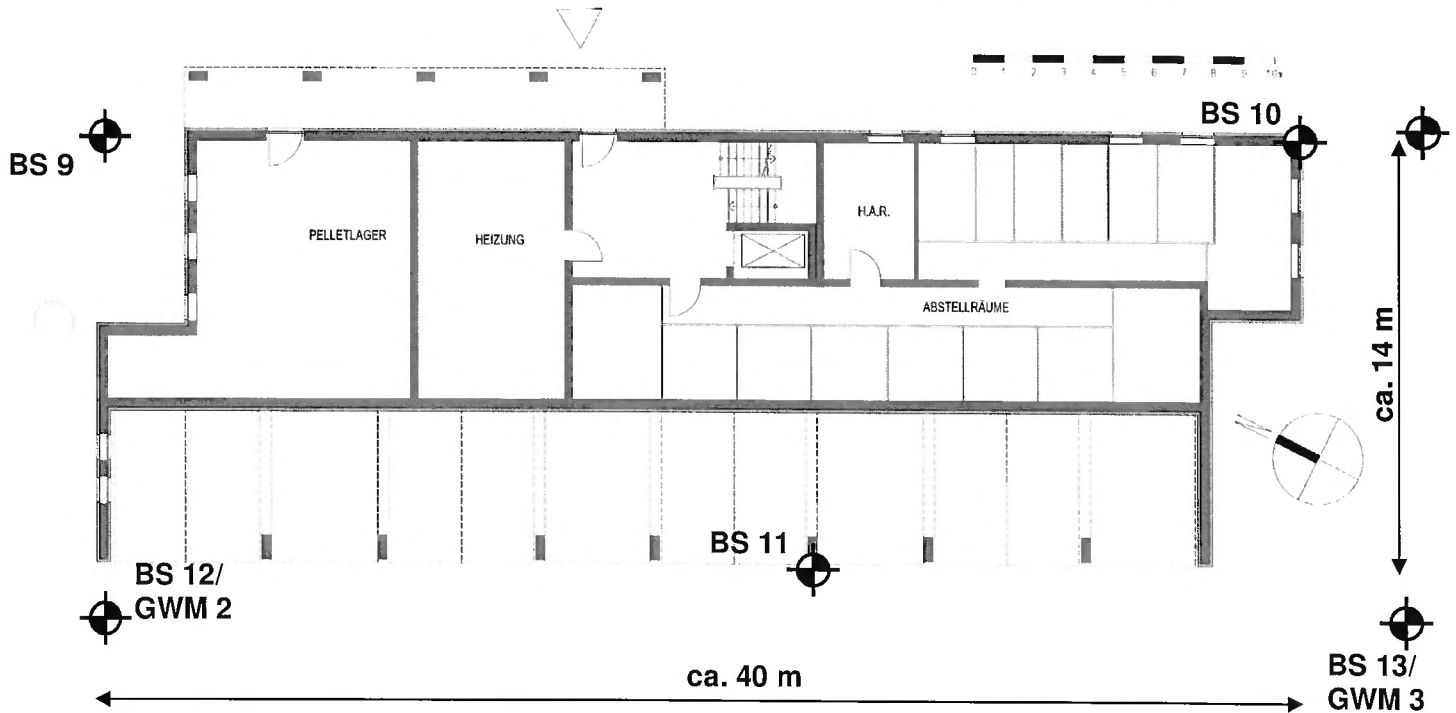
Erdgeschossgrundriss Haus 4, M 1:250
